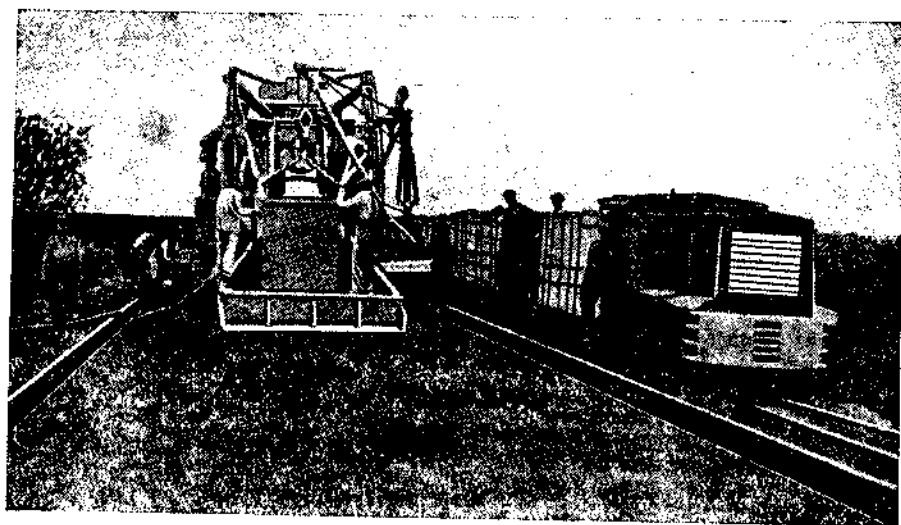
Подача материалов к бетономешалке поездом вагонеток, с выгрузкой вагонеток в ковш поворотным краном бетономешалки.
